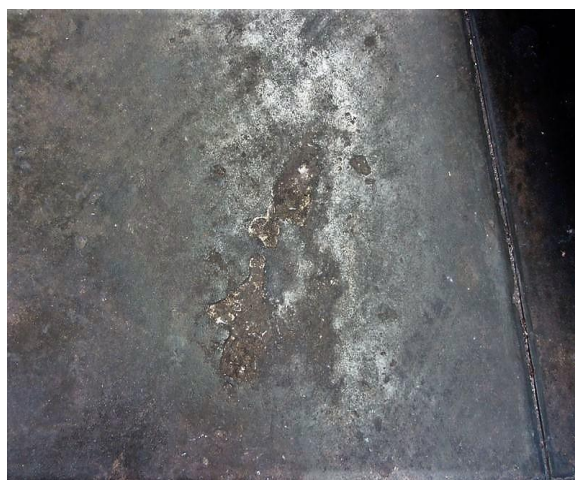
Pormenor do desgaste provocado por cargas excessivas. Fonte: Autor, outubro 2017.
